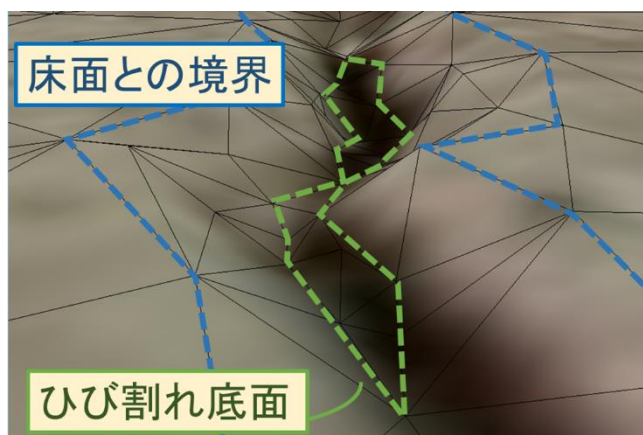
ひび割れ幅0.4mmのモデル拡大図
